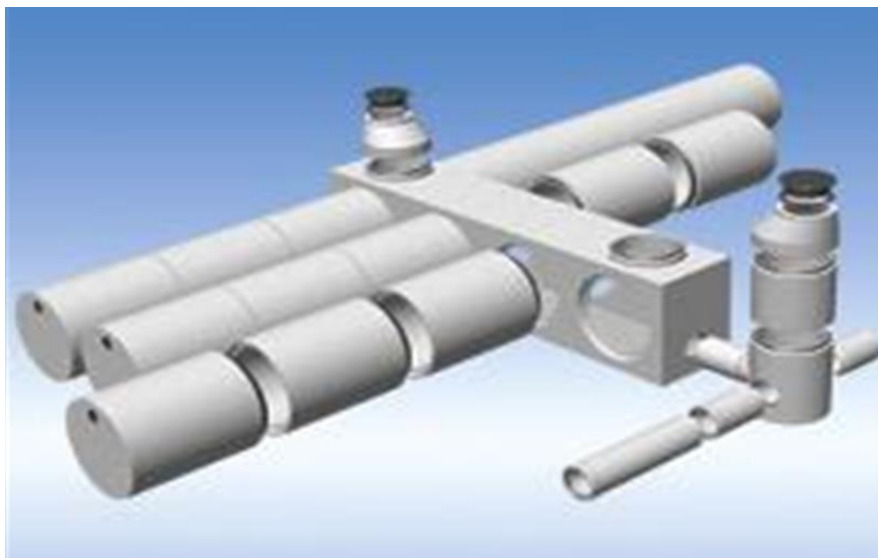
Betongrörsmagasin. Källa: Alfa rör
